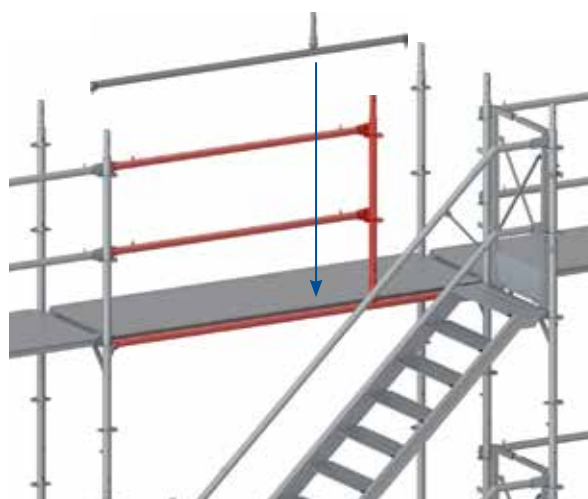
Montage de la lisse de verrouillage d'escalier, du poteau de garde-corps et des renforts de garde-corps
